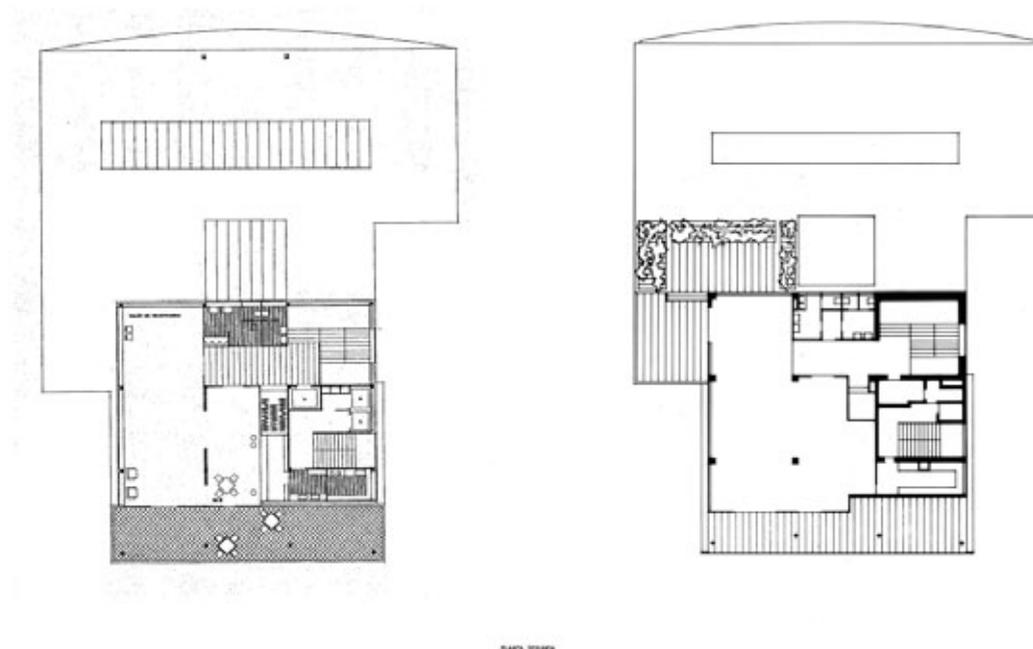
Planta segunda anteproyecto del concurso y proyecto realizado. Fundación Alejandro de la Sota.
